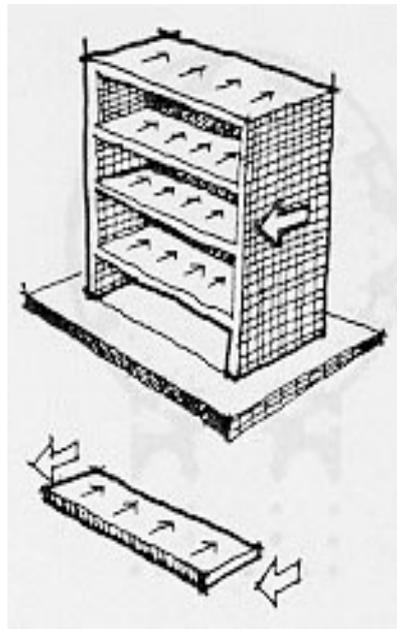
Estrutura em parede com pisos rígidos [7]
